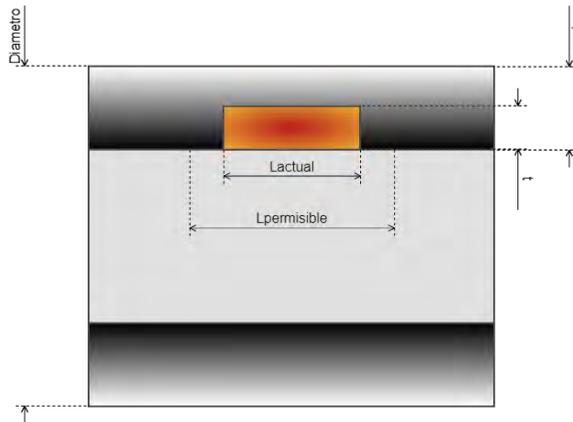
Características dimensionales de la tubería y la grieta
